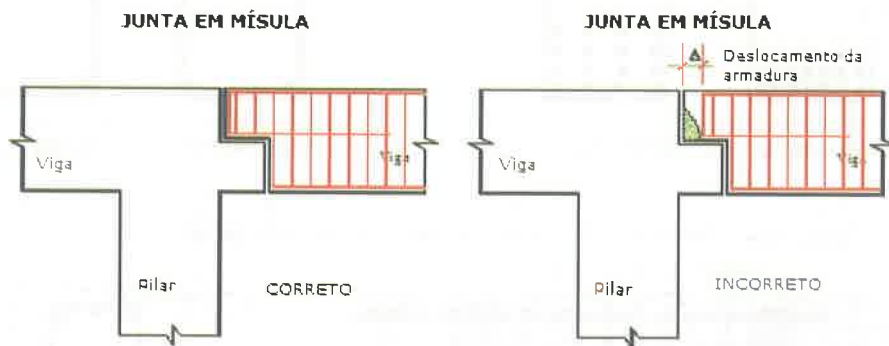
Falhas por mau posicionamento das armaduras
